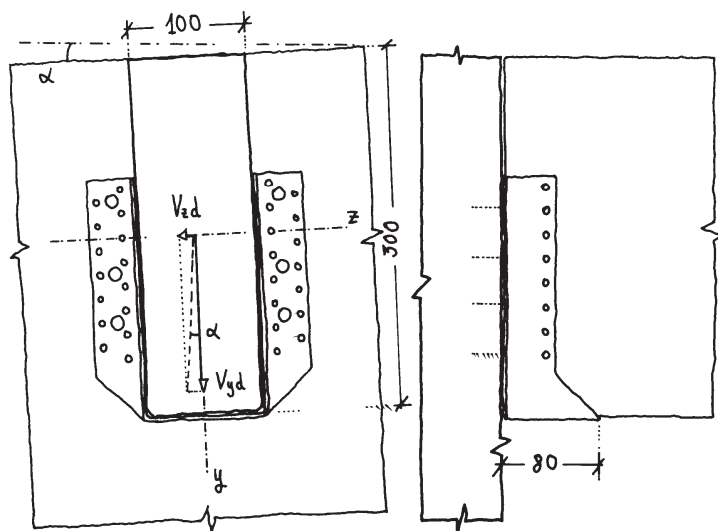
Ejemplo de apoyo de correa de madera laminada encolada.
